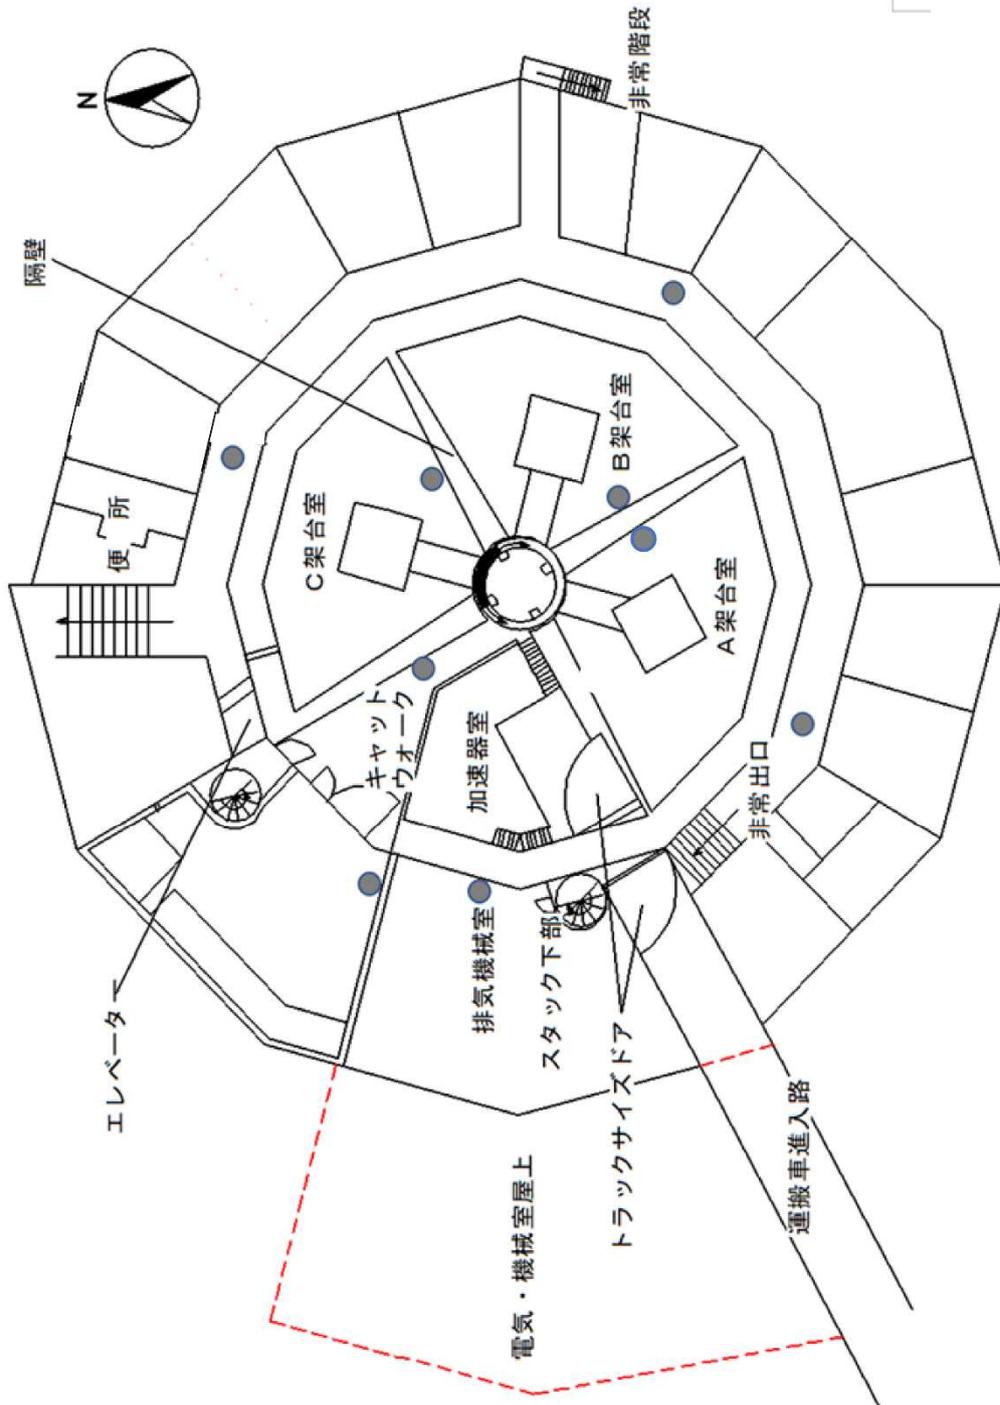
スピーカー配置図 (臨界集集体棟 2階平面図)
